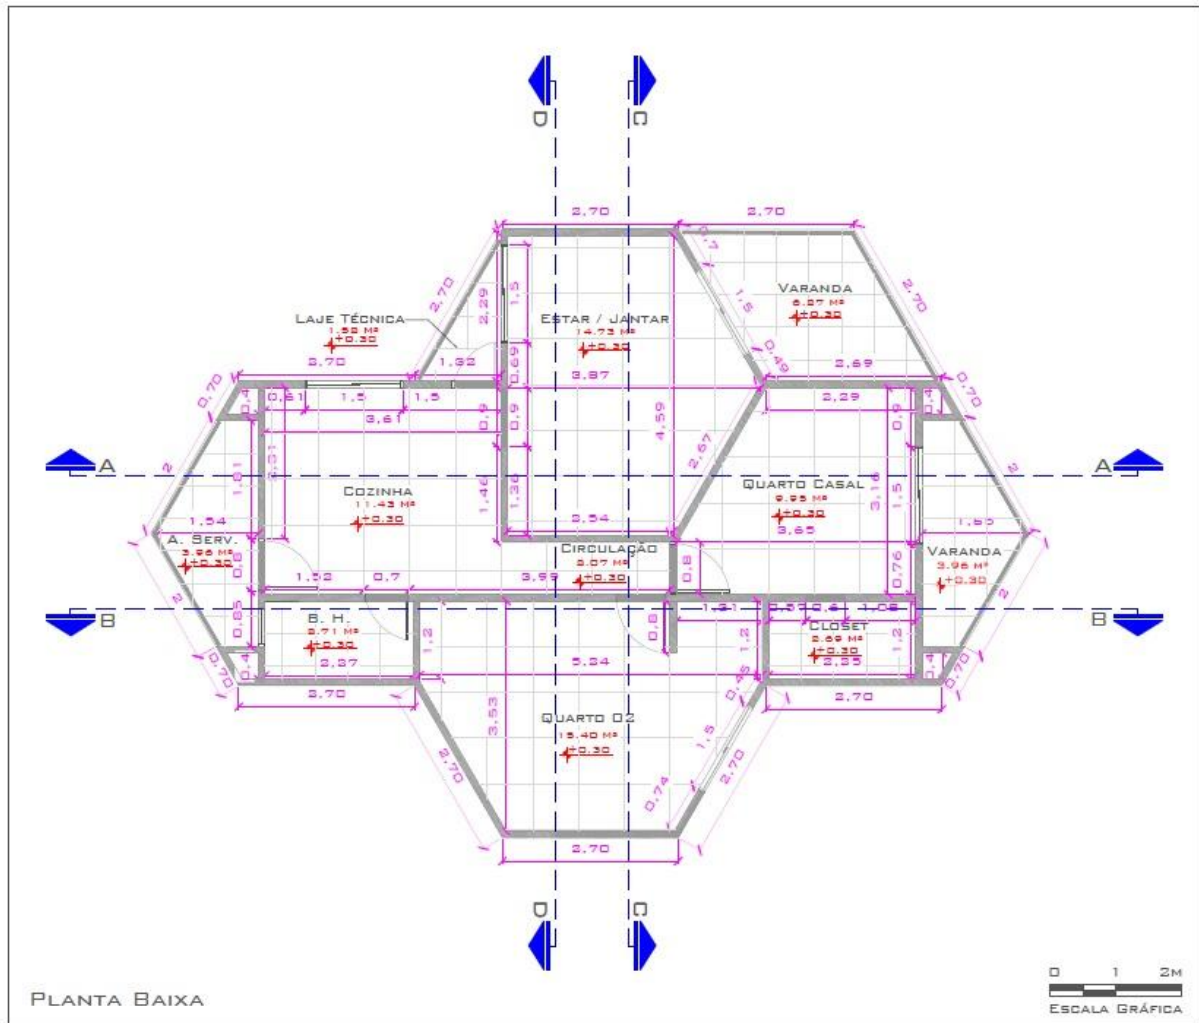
Planta baixa de unidade habitacional. Acervo do autor.
